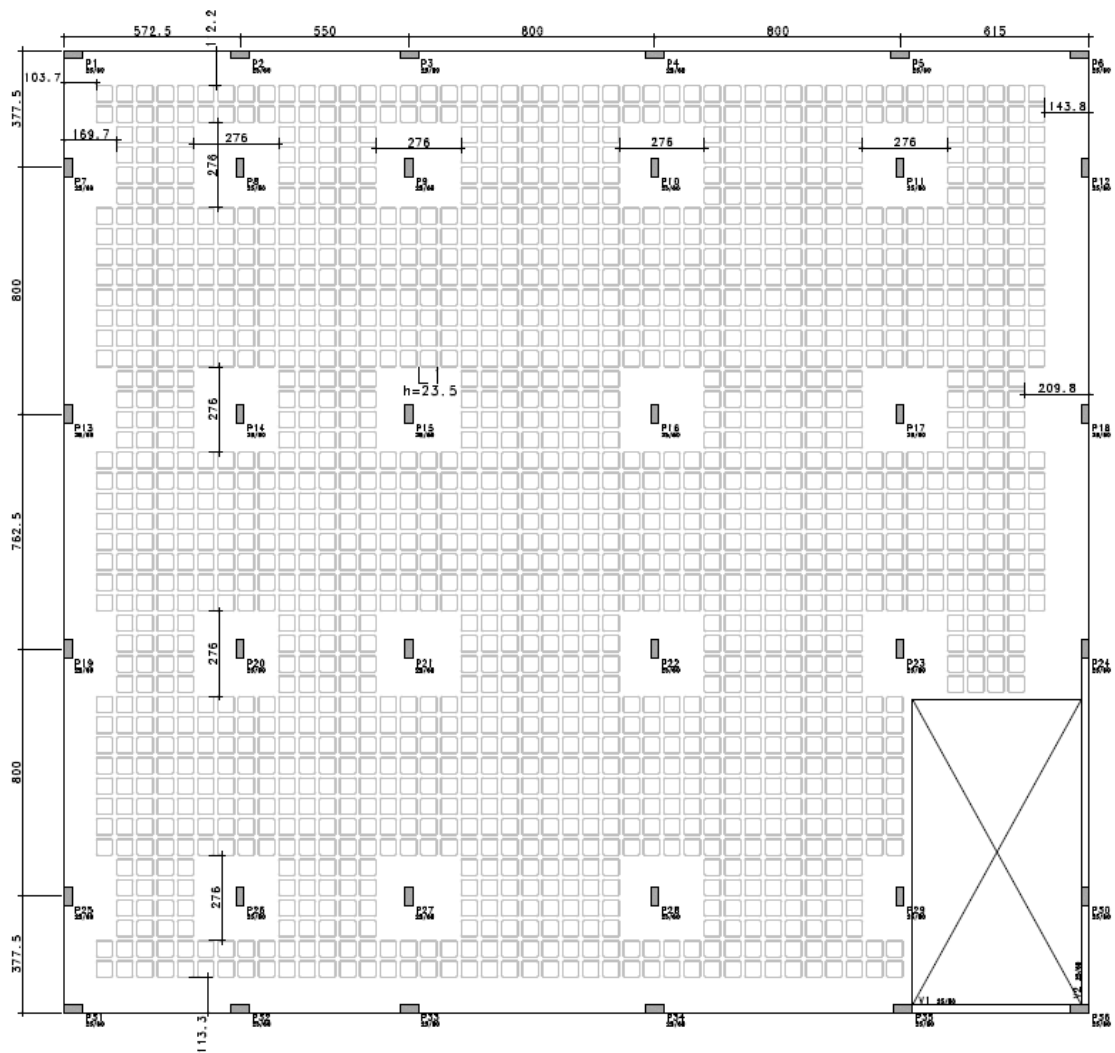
Projeto A2 - Planta de forma (dimensões em cm).
